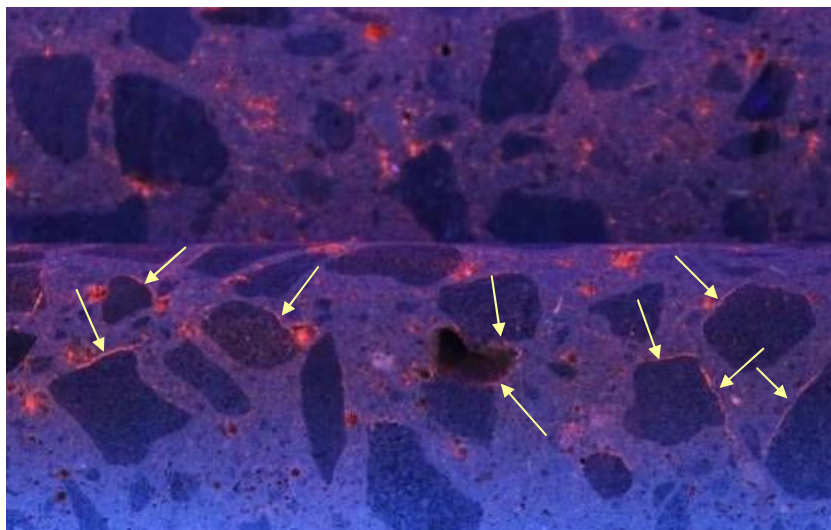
骨材界面に生じたひび割れ
